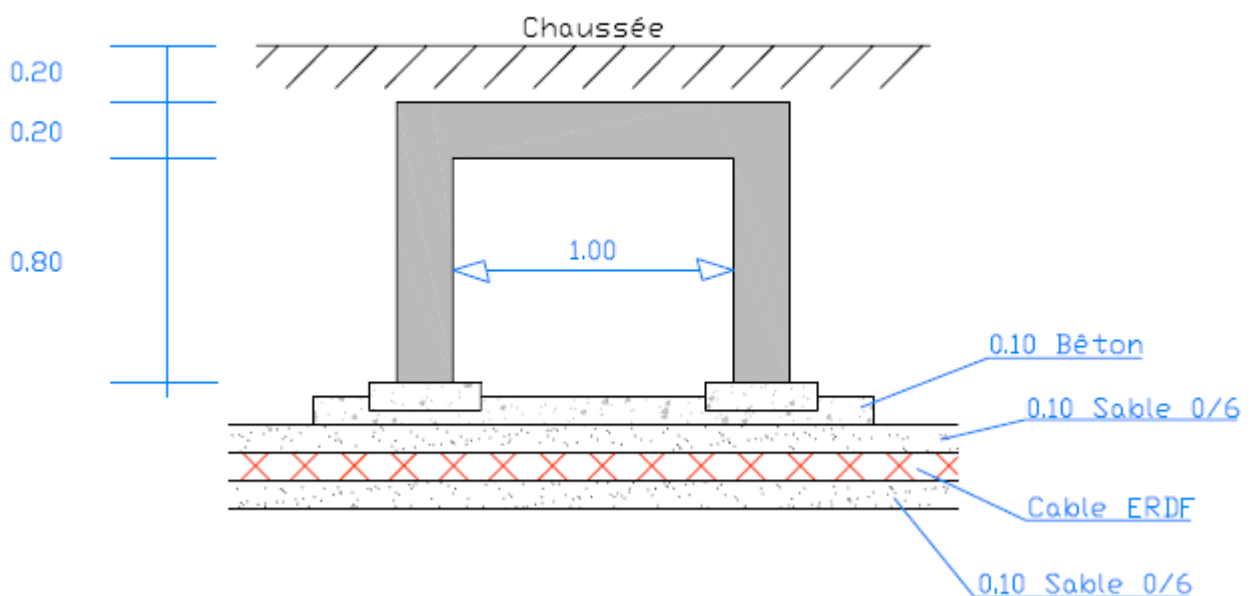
Exemple de coupe de principe d'une traversée disposée sous la RD14 à Geneuille (département du Doubs) – idéalement le substrat doit être terreux dans le fond de la traversée
